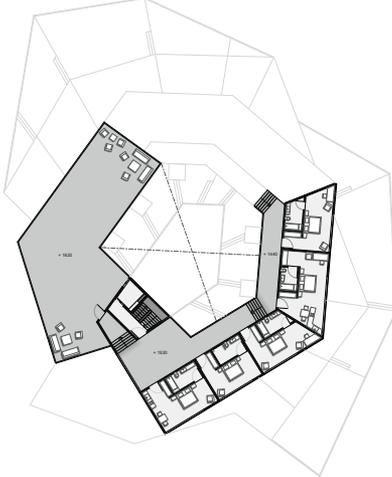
Grundriss +1260 bis +1350 cm
